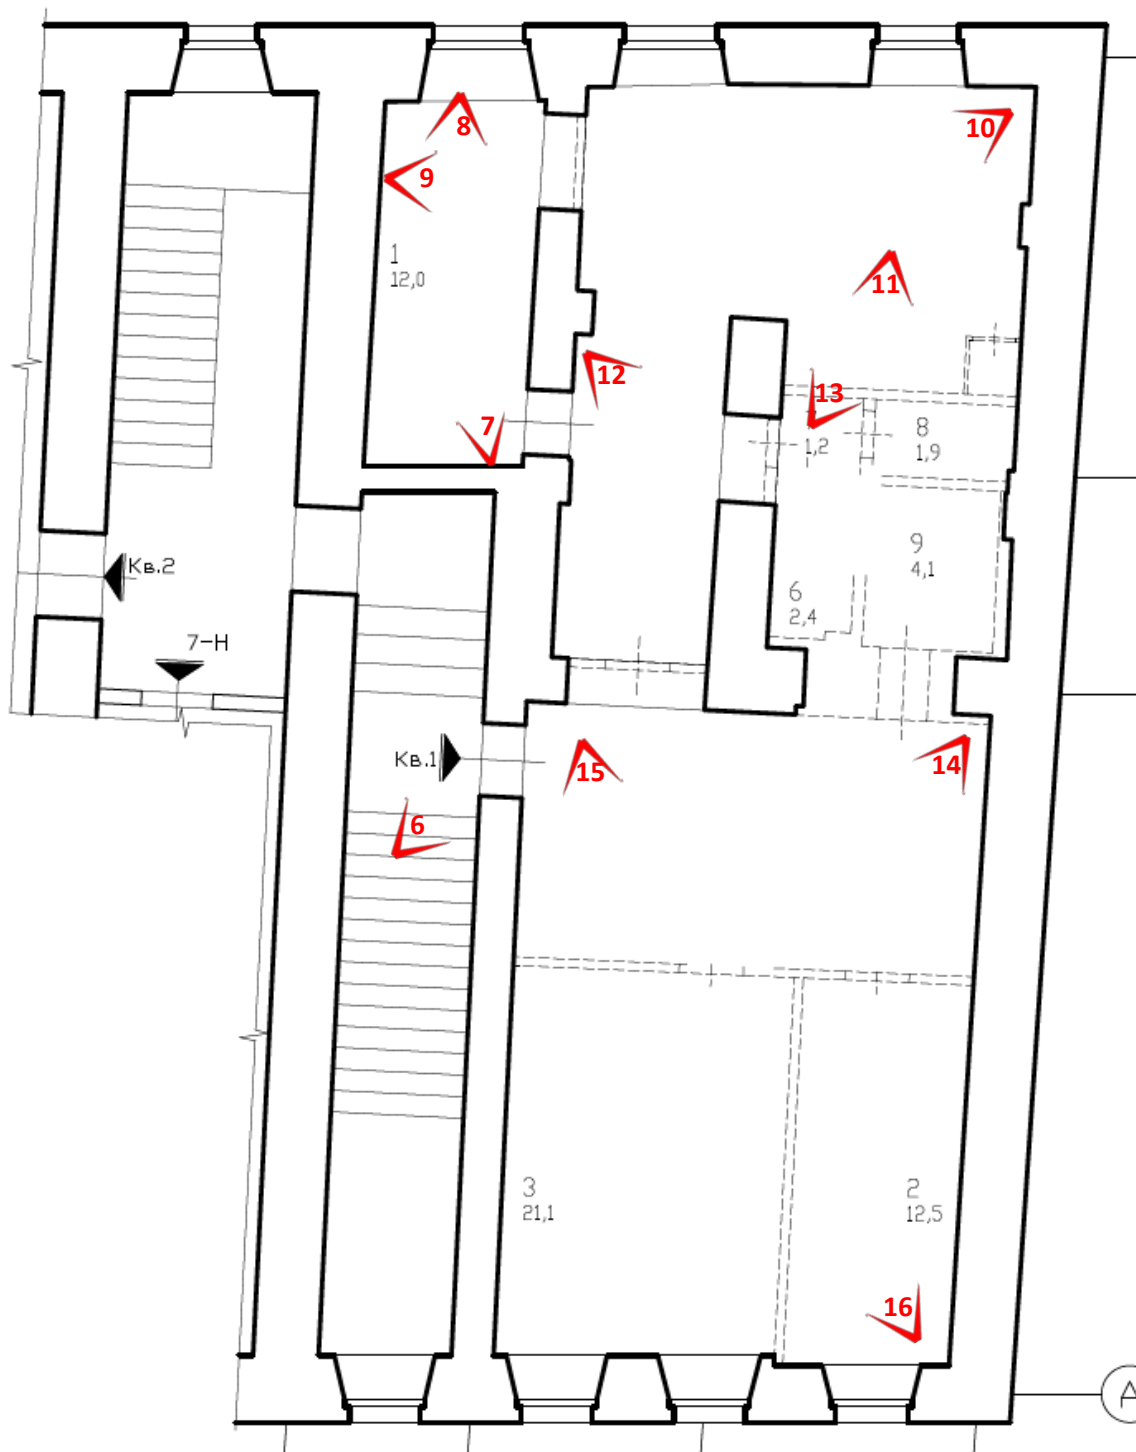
Схема фотофиксации на фрагменте плана 1 этажа
